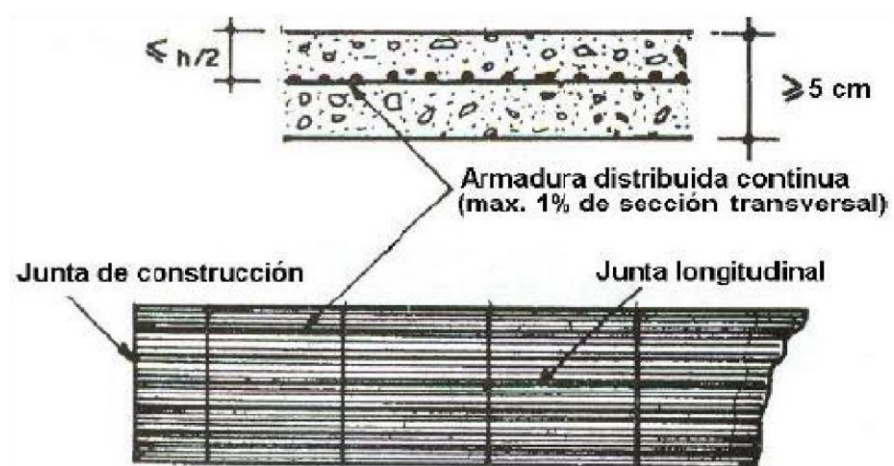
Pavimento con refuerzo continuo Fuente: AASHTO 93
